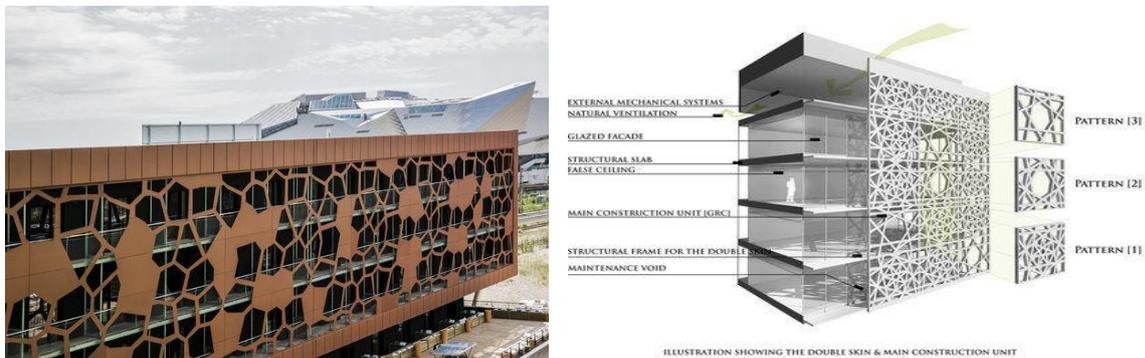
façade double peau (Source : www.maison.com, www.pinterest.com)
